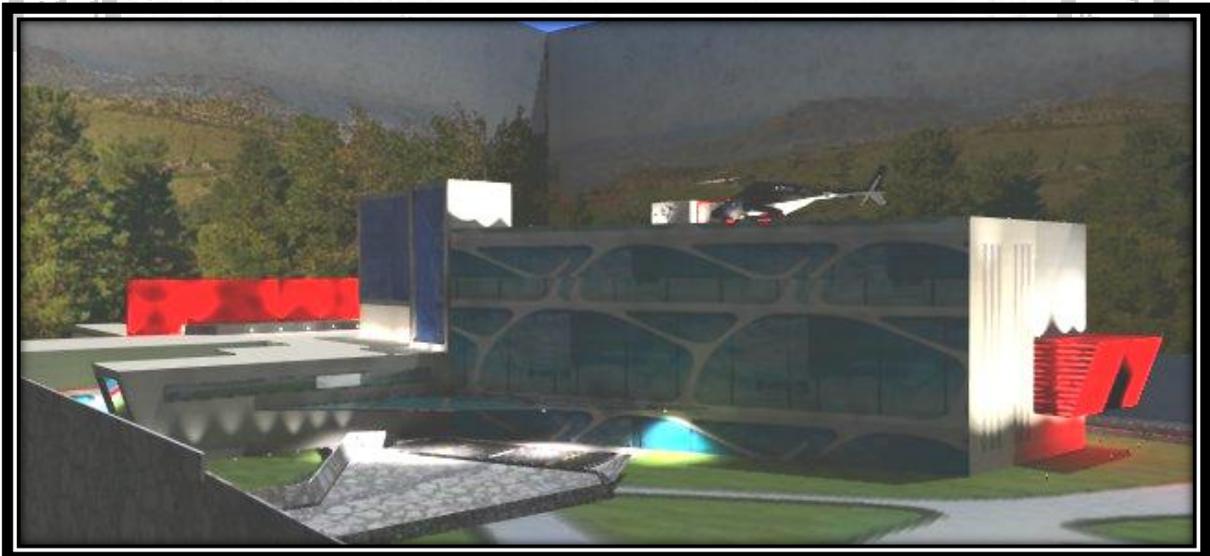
Elaboración Propia----- Fachada Posterior INACIF
